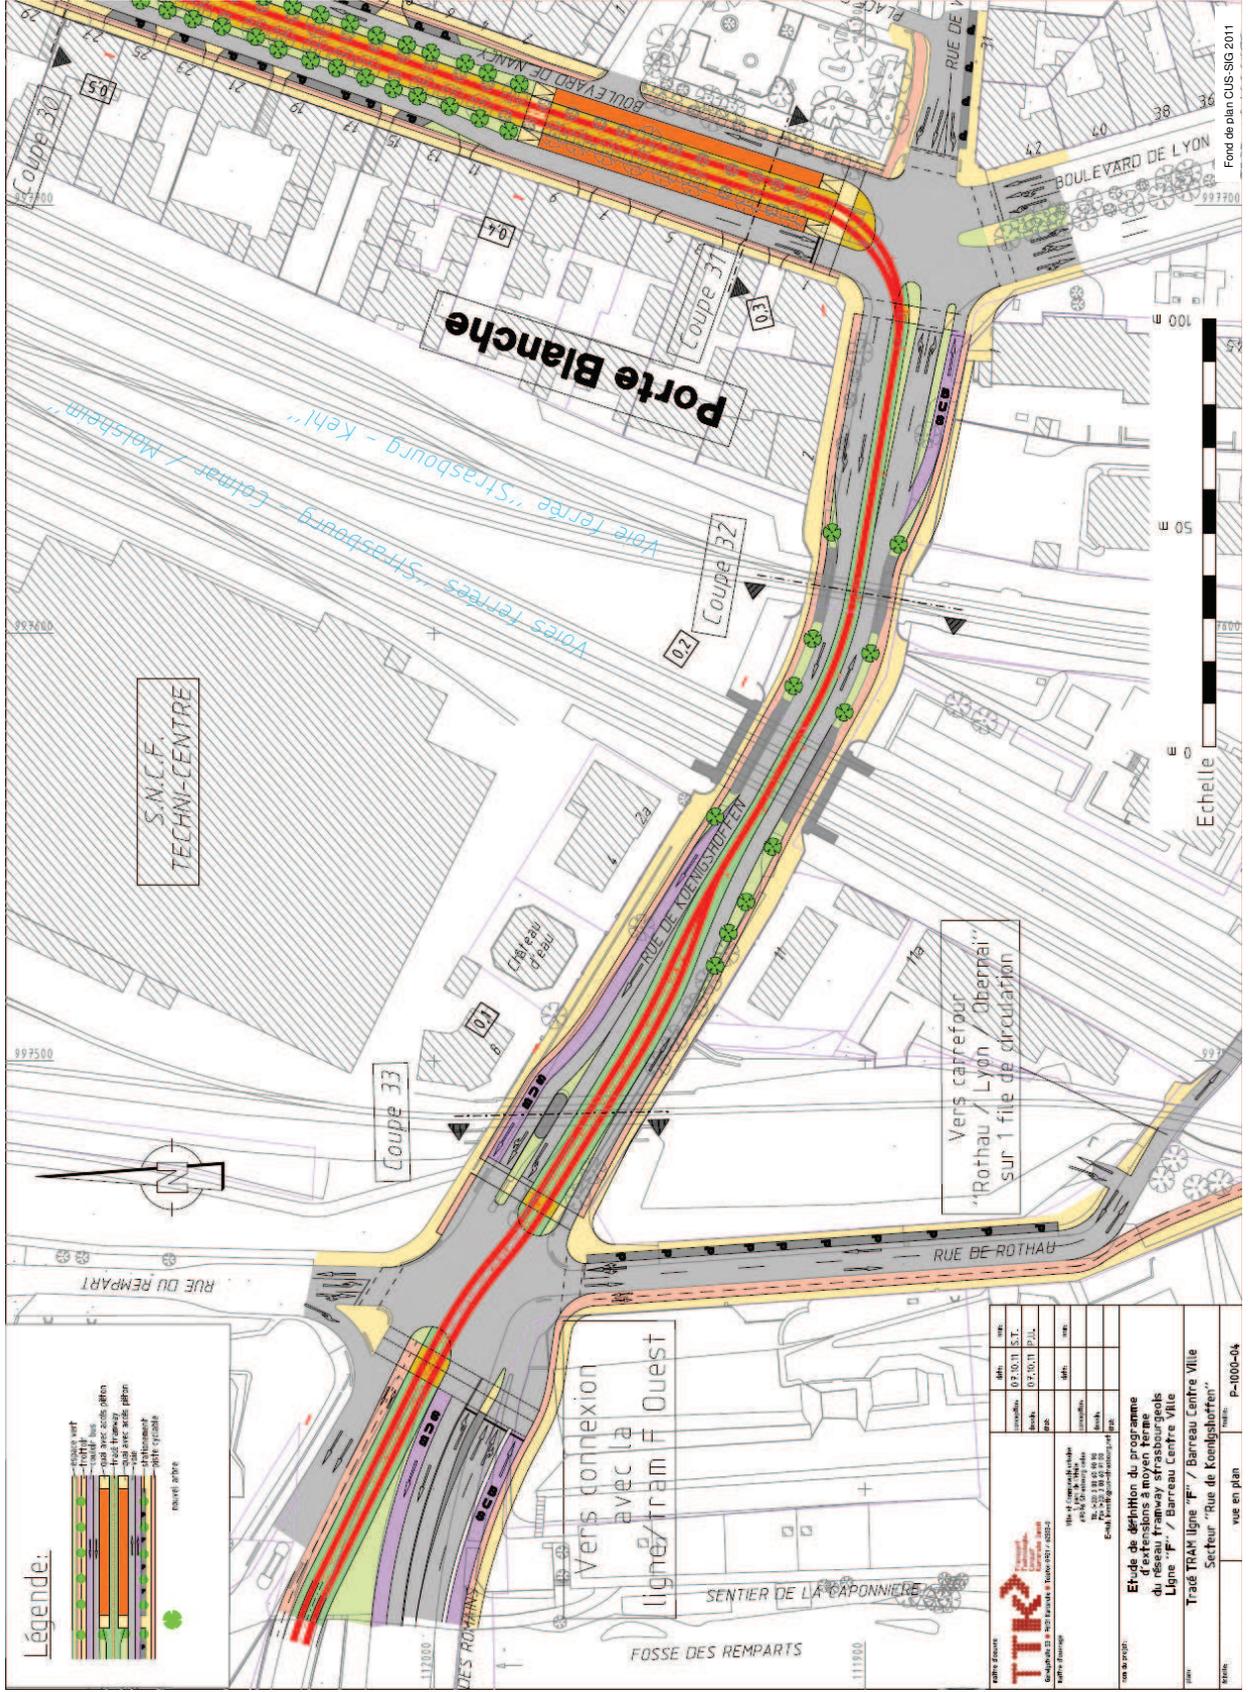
Plan d'insertion du secteur rue de Koenigshoffen (échelle 1/1350^{ème})
